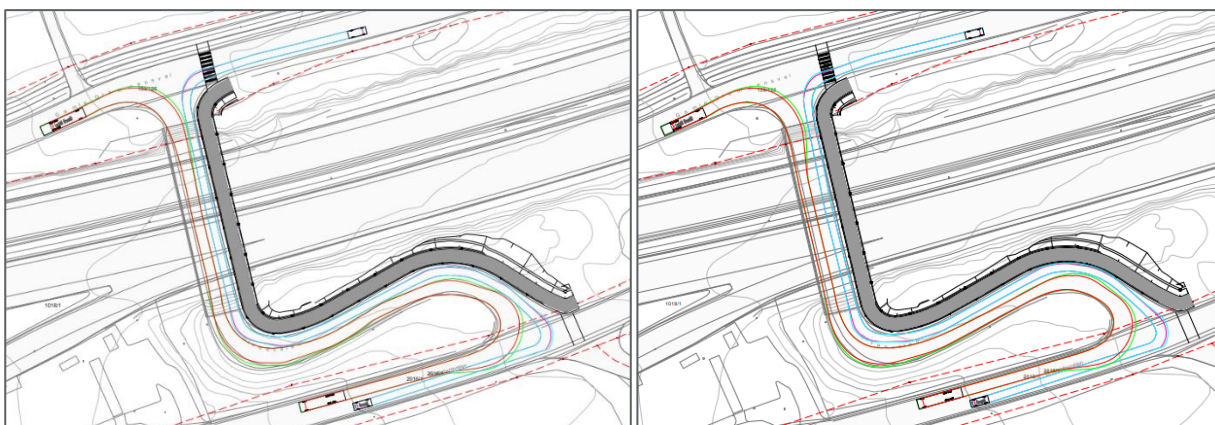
Sporing lastebil. Venstre: Østre bankett fjernet. Høyre: Begge banketter fjernet.
